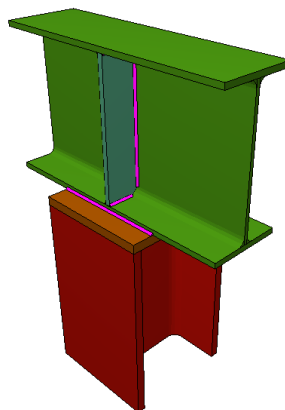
Soldadura de la viga carrilera con el pilar
